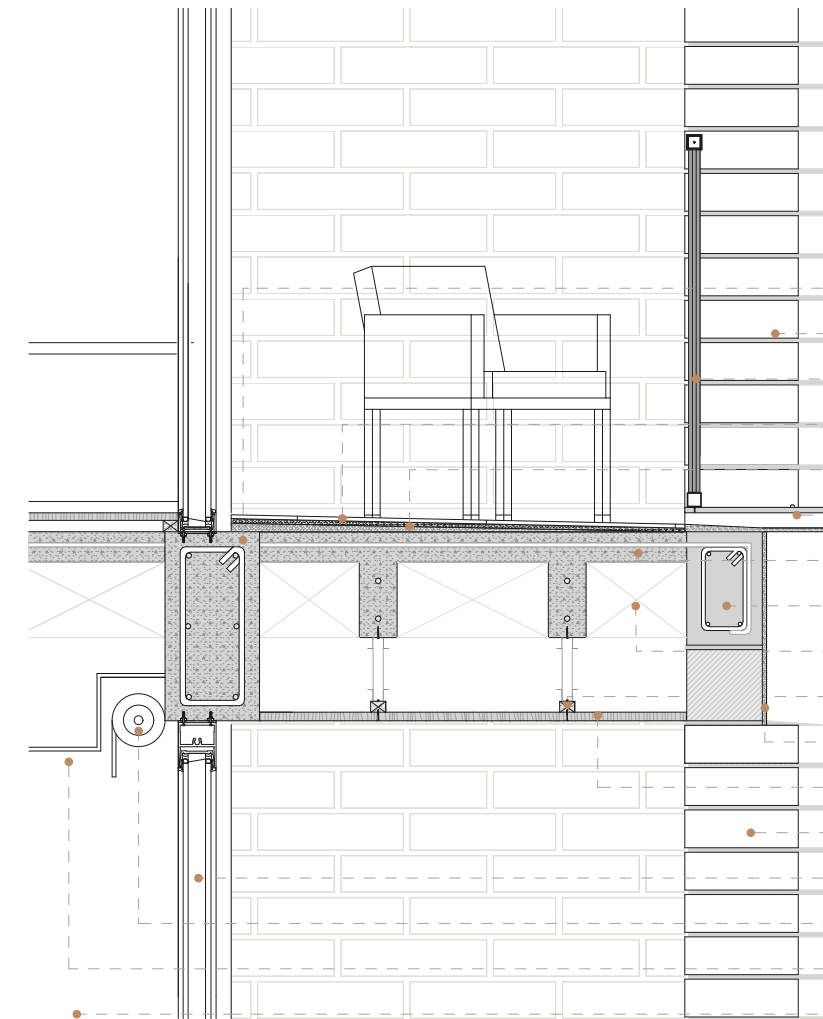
Detalle entrepiso. Fuente: Autoría propia.
